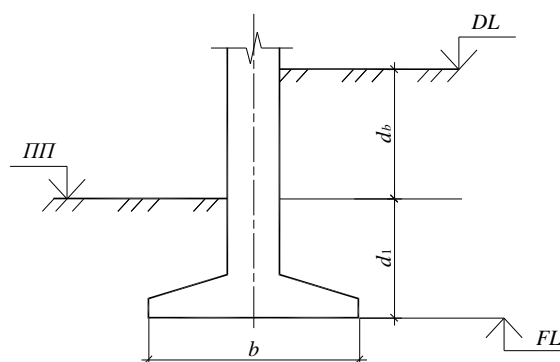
Схема одиночного прямоугольного (в плане) фундамента с подвальными помещениями ( $d_b$  – глубина подвала - расстояние от уровня планировки до пола подвала, м)
